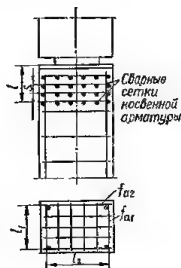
Косвенное армирование конца железобетонного элемента сварными сетками.
